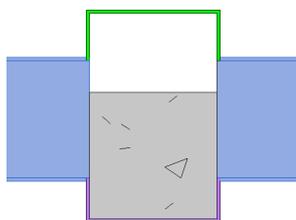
Rivestimento di cavedio impiantistico adiacente a pilastro strutturale
